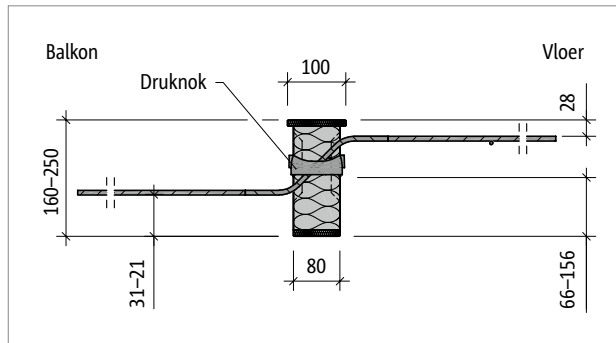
Schöck Isokorf® T type Q-E-V7: Doorsnede
